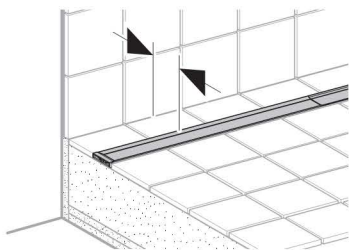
Grundriss der nicht produktspezifischen Einlegeposition für alle Geberit Abläufe für bodenebene Duschen
